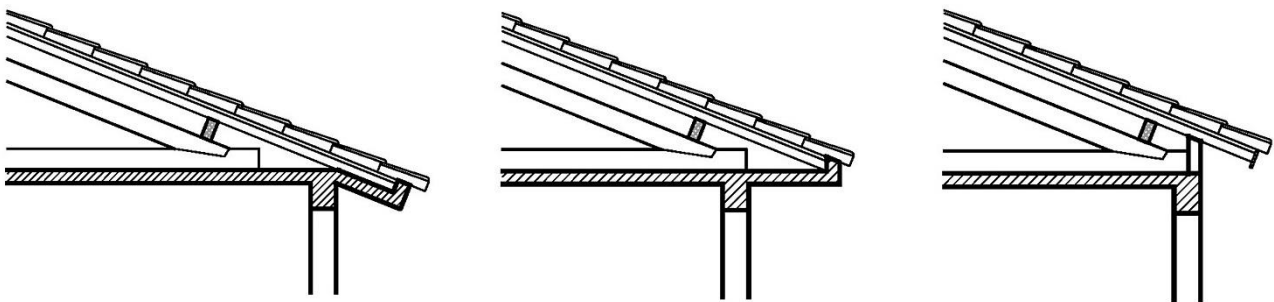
Da esquerda para direita: beiral de concreto inclinado, beiral de concreto plano, e beiral em vã. Fonte: autor
